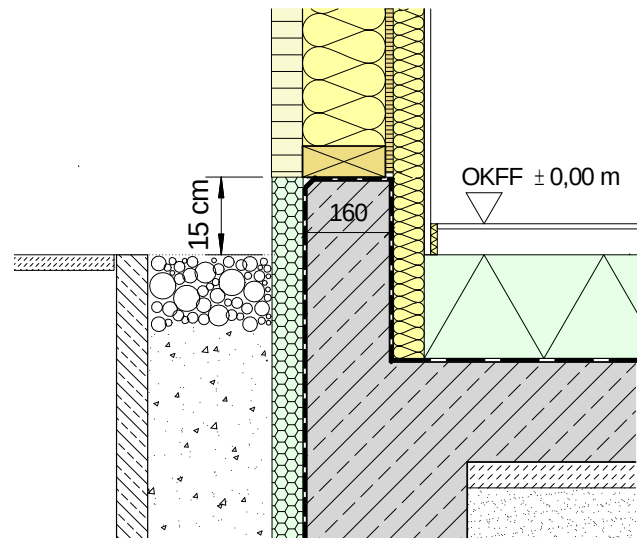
Wärmetechnik ist diese Betonaufkantung in Ordnung. Die Perimeterdämmung ist weit ins Erdreich geführt. Außerdem wurde eine gedämmte Installationsebene angeordnet. Die vertikale Abdichtung verbleibt unterhalb der Holzbaukonstruktion (vgl. Abb. G1.20).
